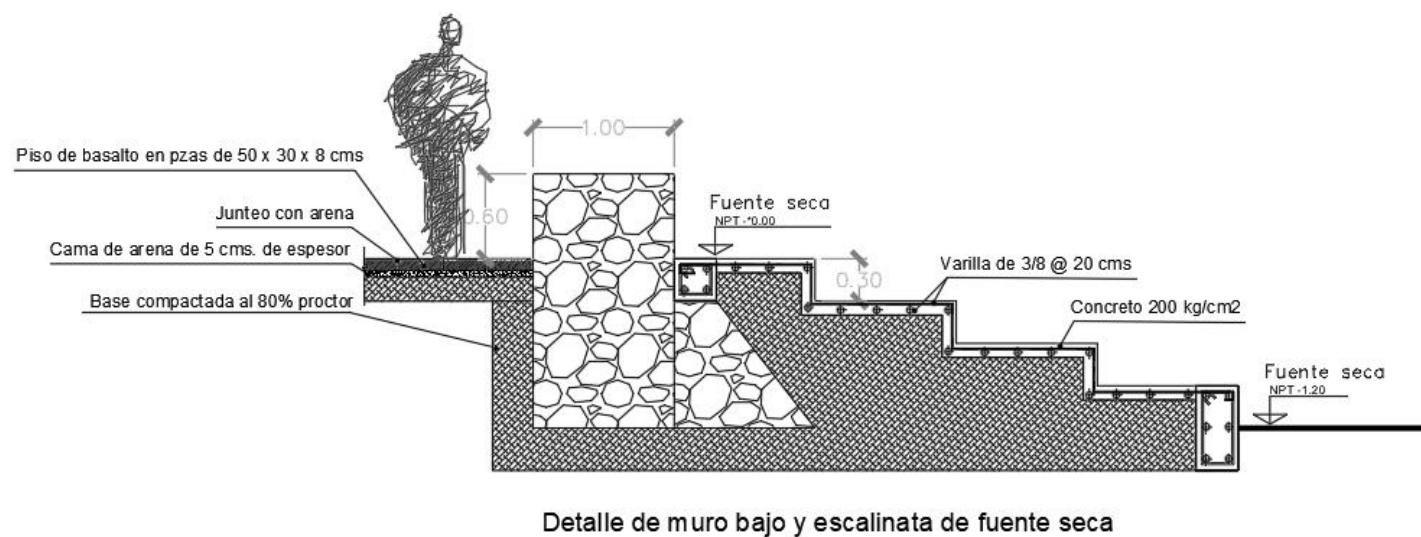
Propuesta de muro bajo de piedra y escalinata en torno a fuente seca (Elaboración propia).
